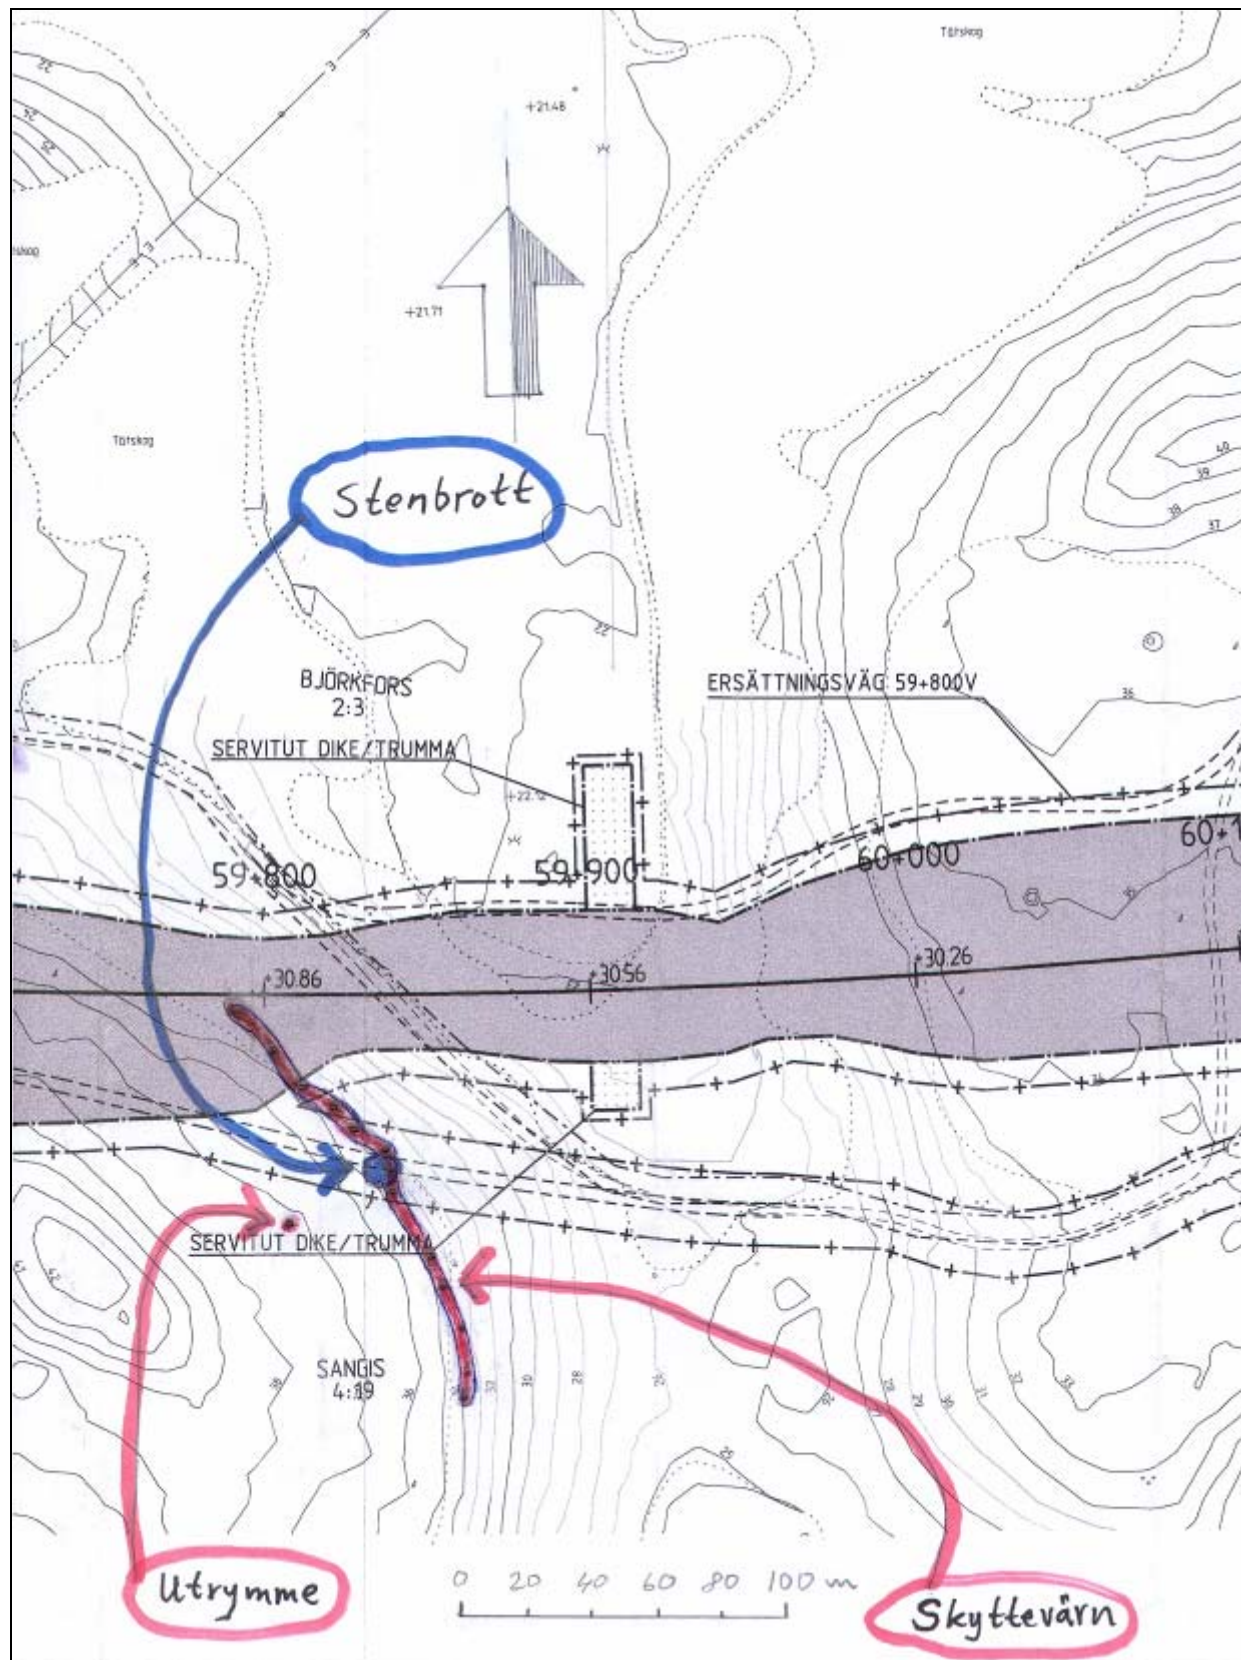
Utdrag ur Banverkets planritning JP 12-101, blad 07, upprättad av WSP 2007-02-01, kompletterad med skalstreck och läget för dokumenterade kulturlämningar. Teckenförklaring, se bilaga 1.
